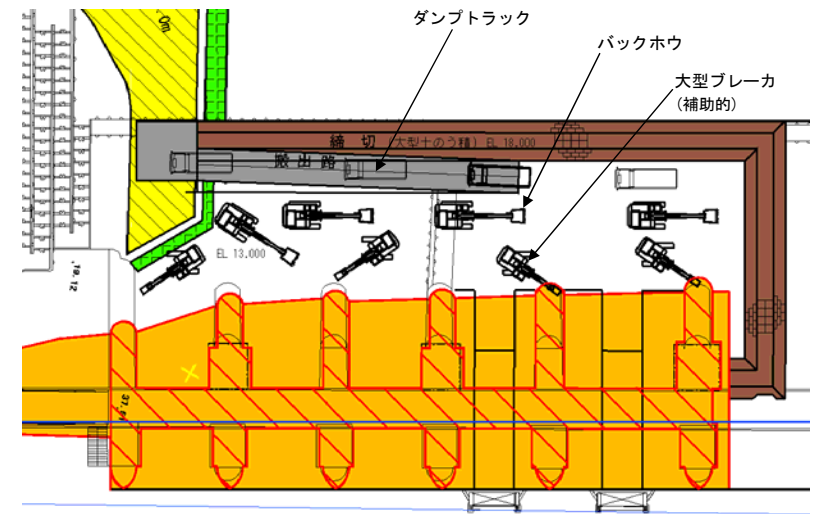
機械設備配置図（第5段階：ピア部撤去時）
